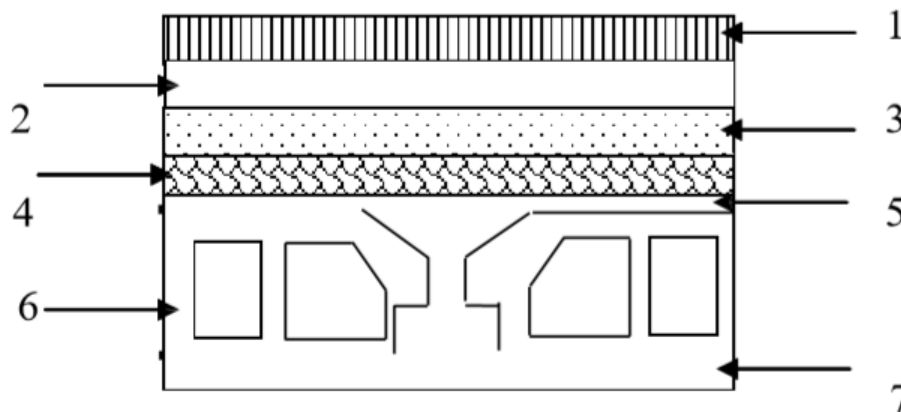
Coupe du plancher terrasse inaccessible.
